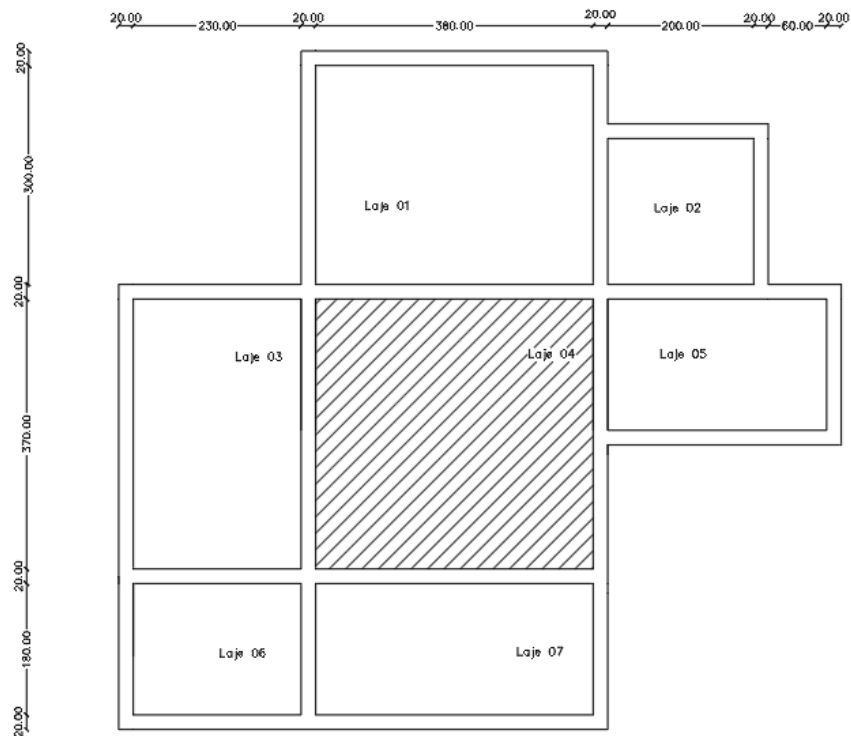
Planta baixa utilizada para o dimensionamento da laje.
